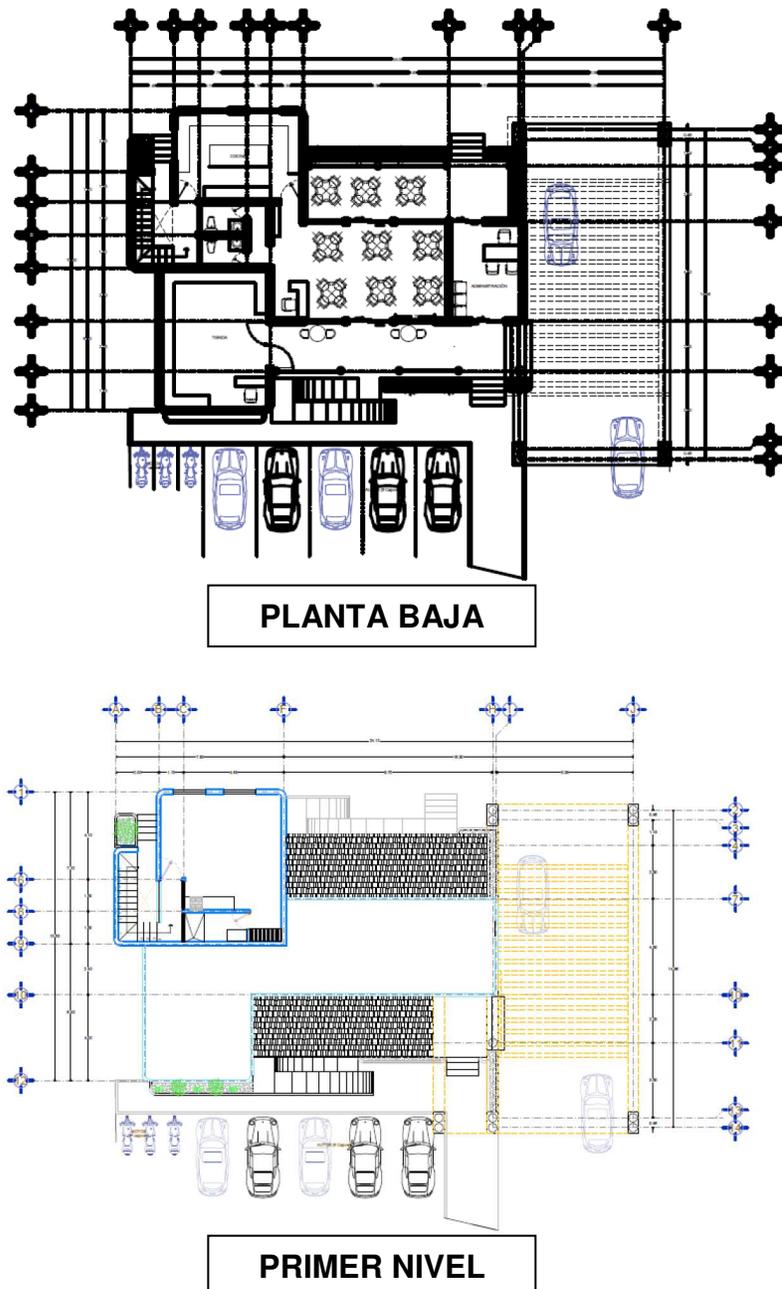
Planta de conjunto de planta baja y primer nivel del restaurante.
